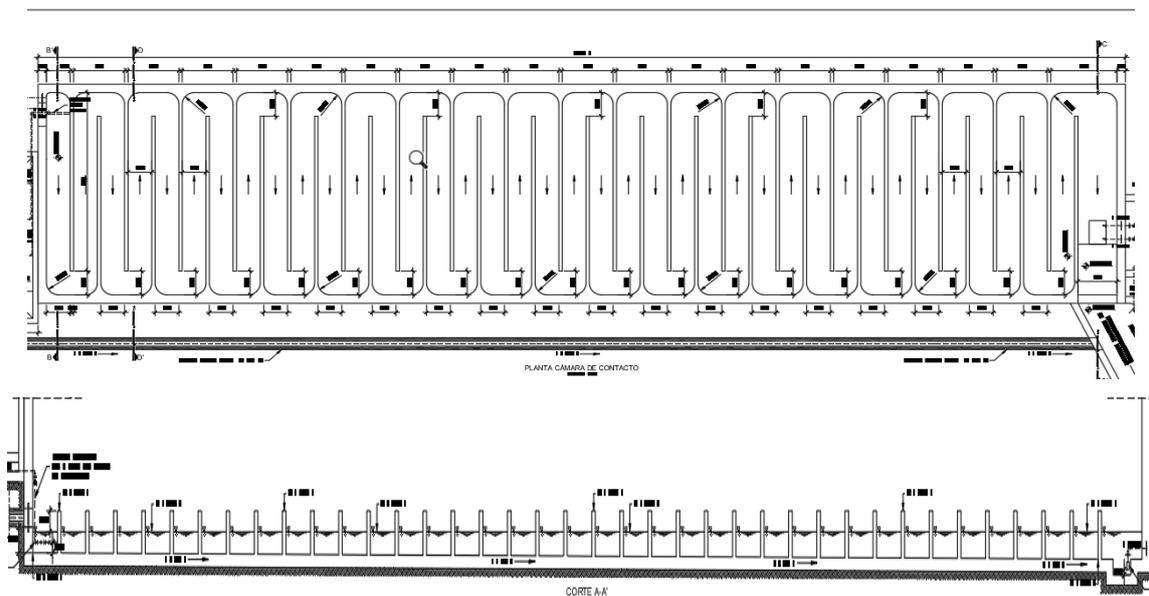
Vista de planta y perfil de la cámara de contacto de cloro.
